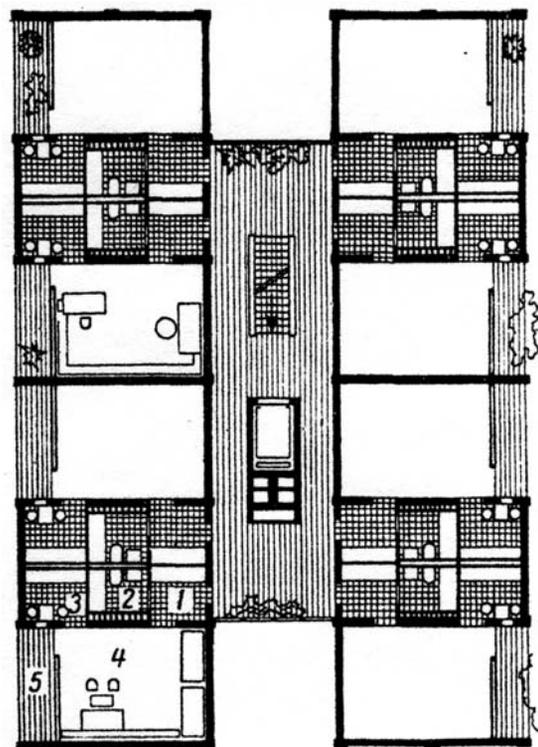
Дом гостиничного типа в г. Годесберге (ФРГ). План жилого этажа: 1 – передняя; 2 – совмещенный санузел; 3 – кухня; 4 – жилая комната; 5 – балкон
